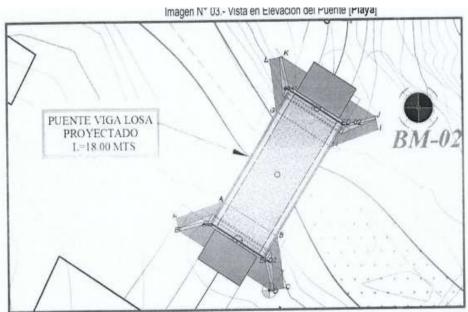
Vista en planta de la Ubicación del Puente Playa
